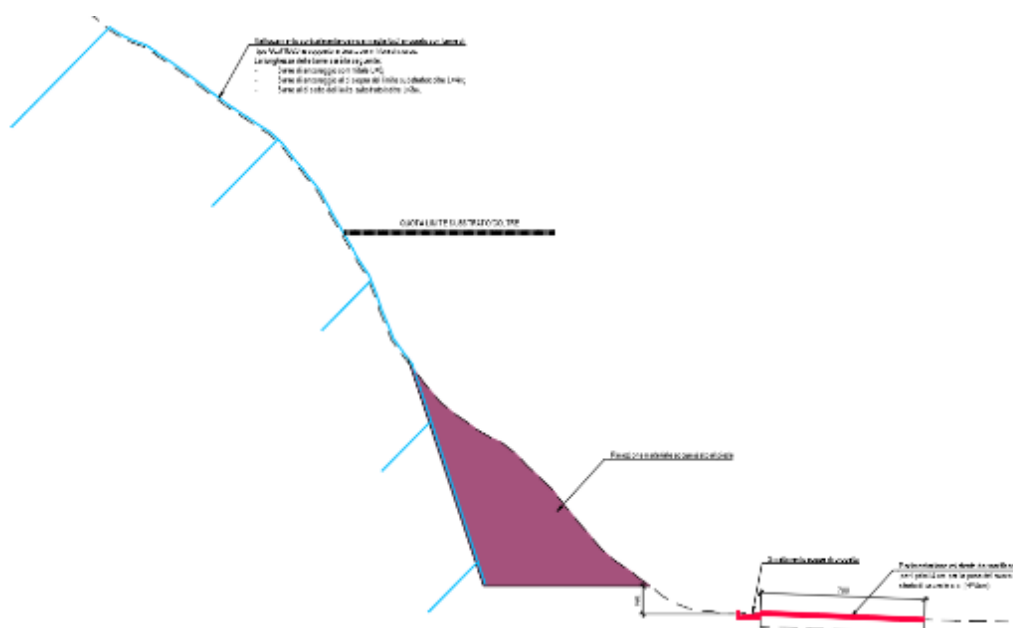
sezione tipo rafforzamento corticale a maglia 6.00x3.00m con antierosivo
